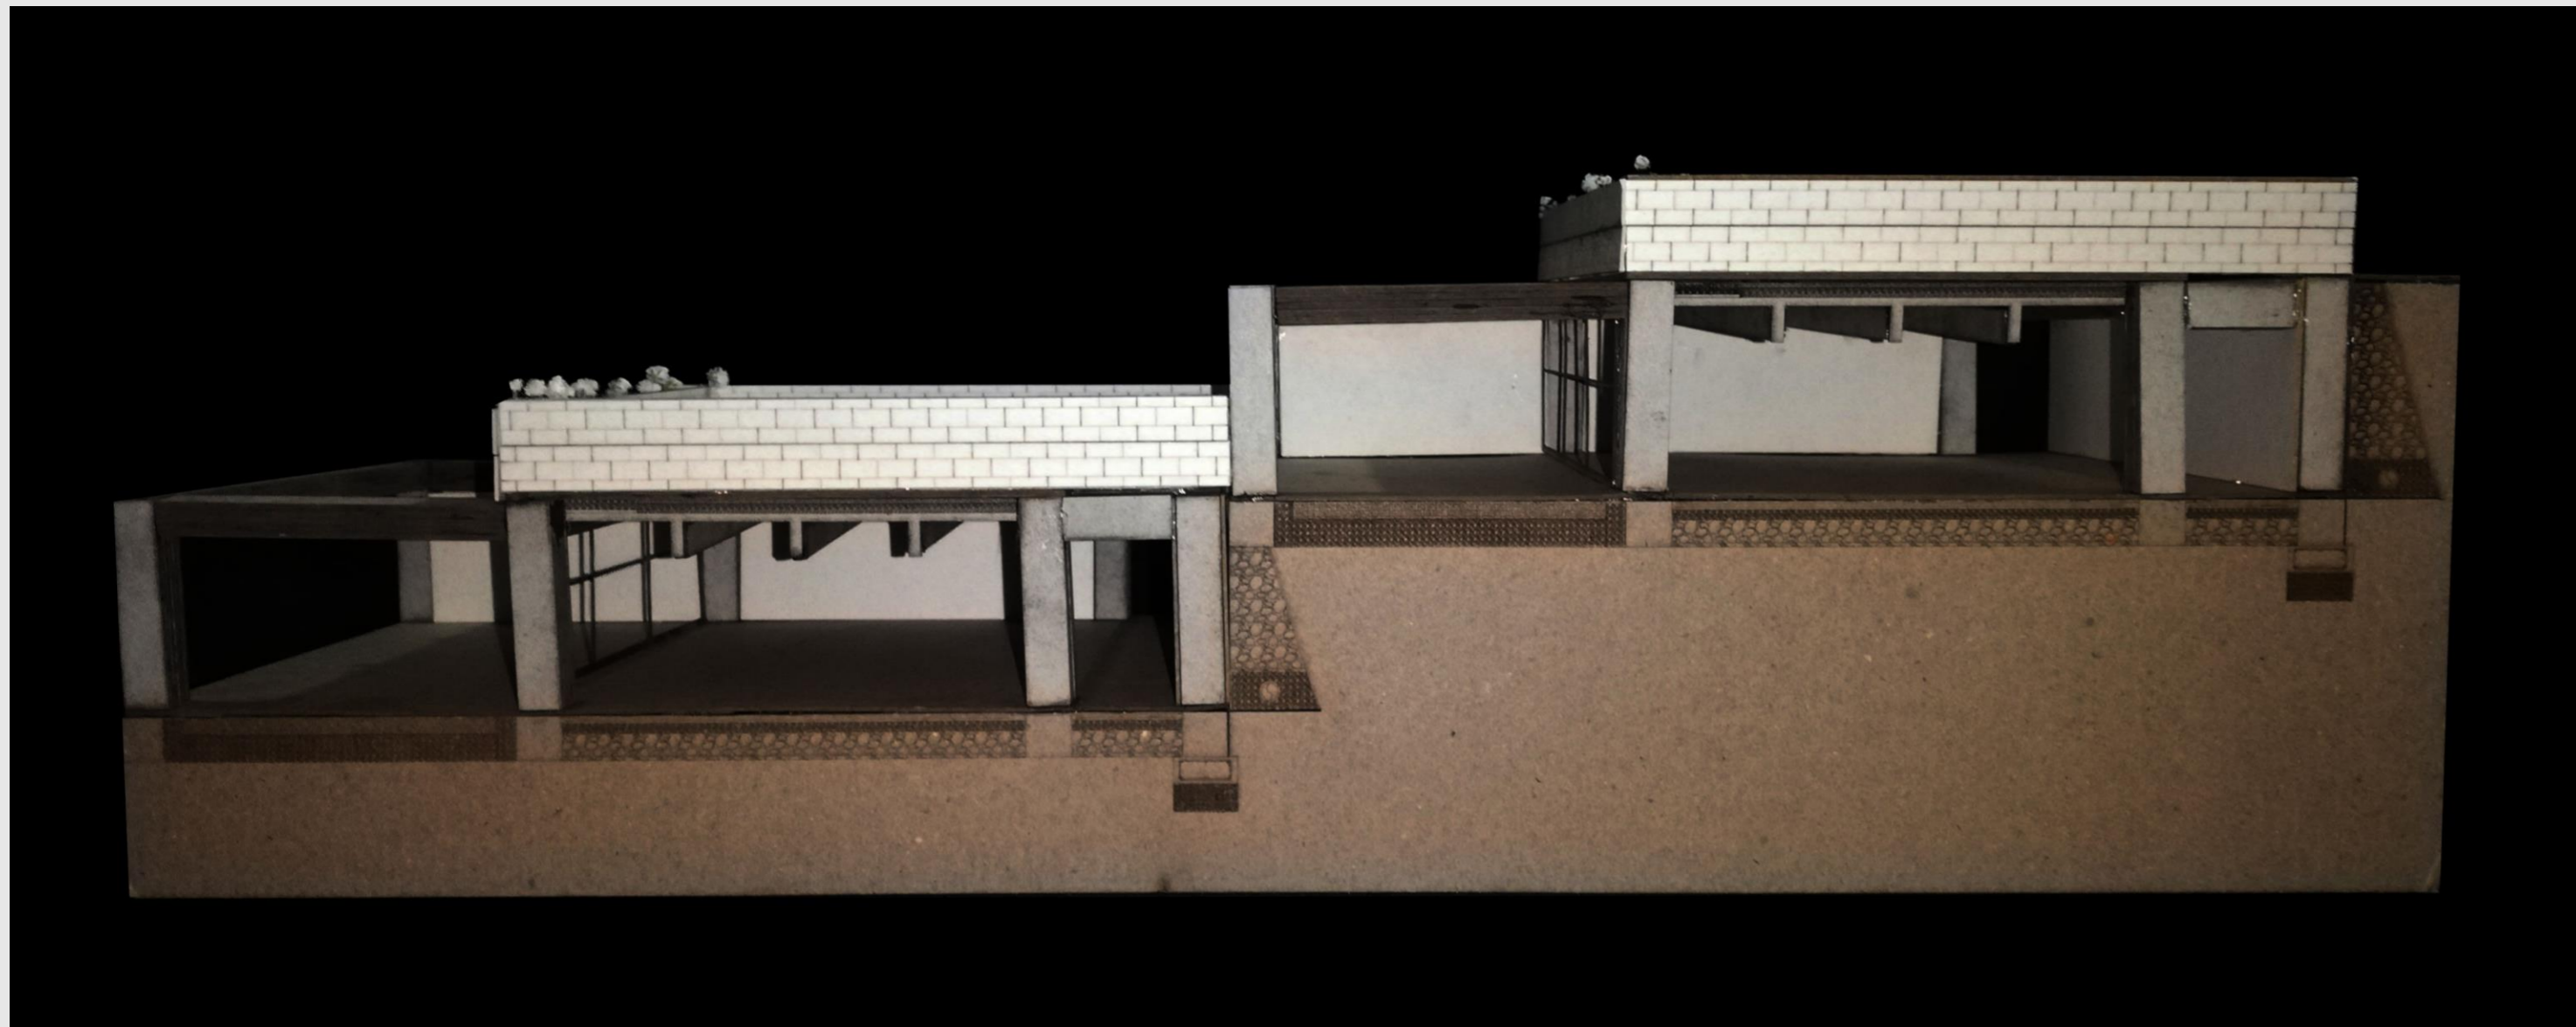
, Fotografía maqueta detalle constructivo. Espinosa V. (2021)
